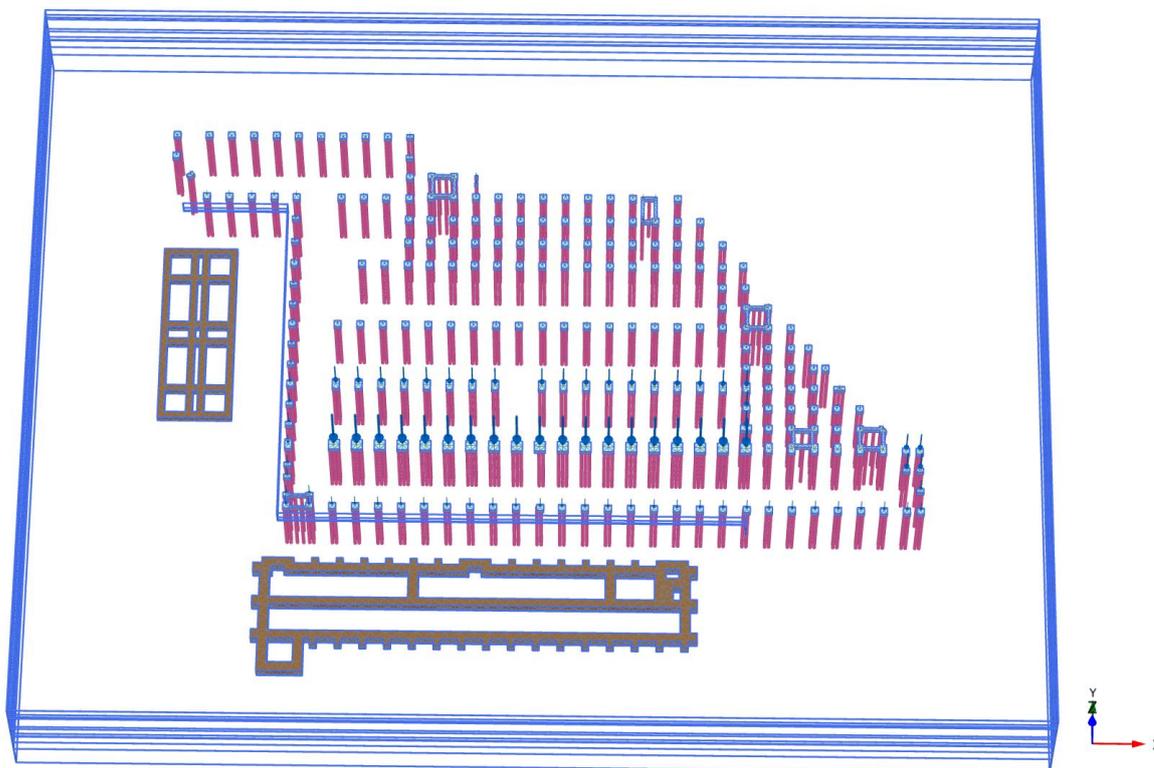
Конструкции фундаментов исторических зданий и Трубообрабатывающего комплекса
